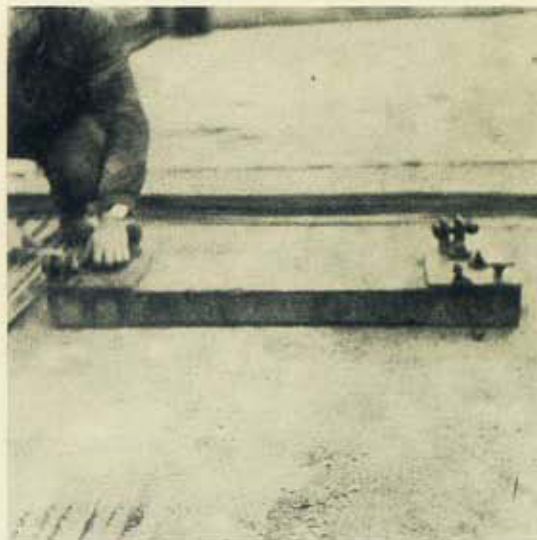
Colocação da base dos esticadores. A sua prisão ao pavimento é feita por intermédio de furos obtidos na preparação da peça de betão do pavimento.
